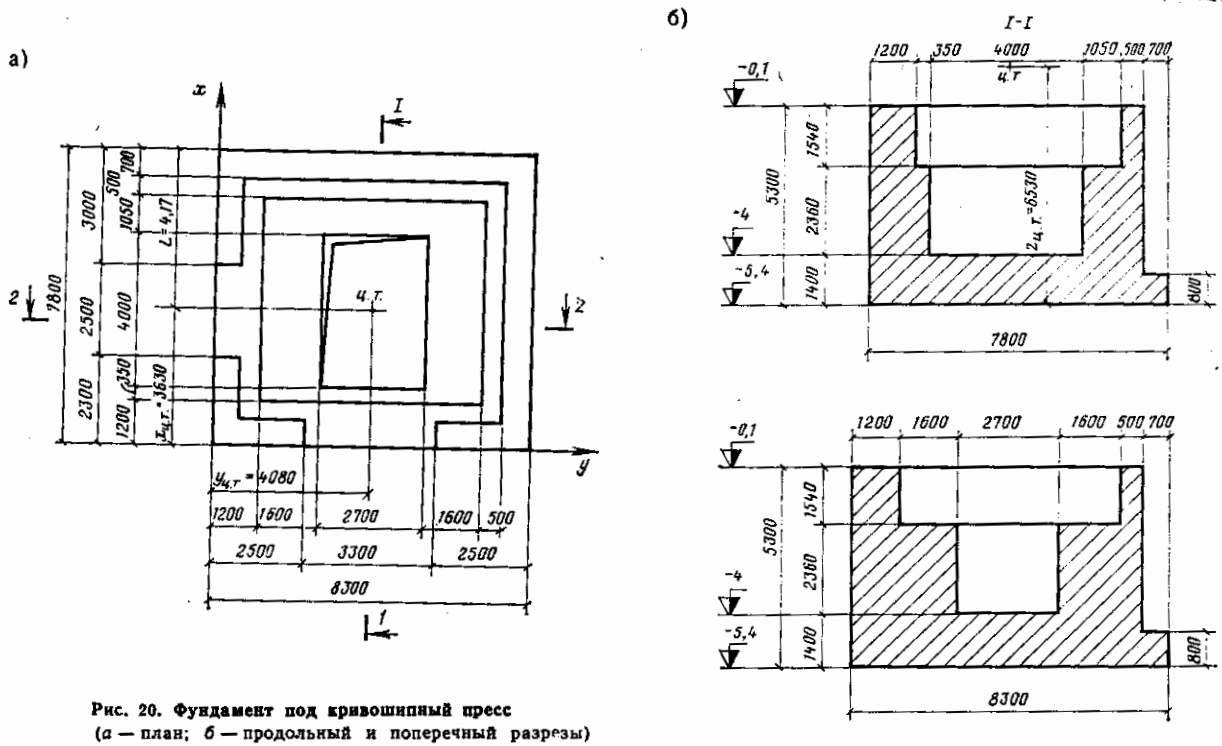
Фундамент под кривошипный пресс (а — план; б — продольный и поперечный разрезы)
